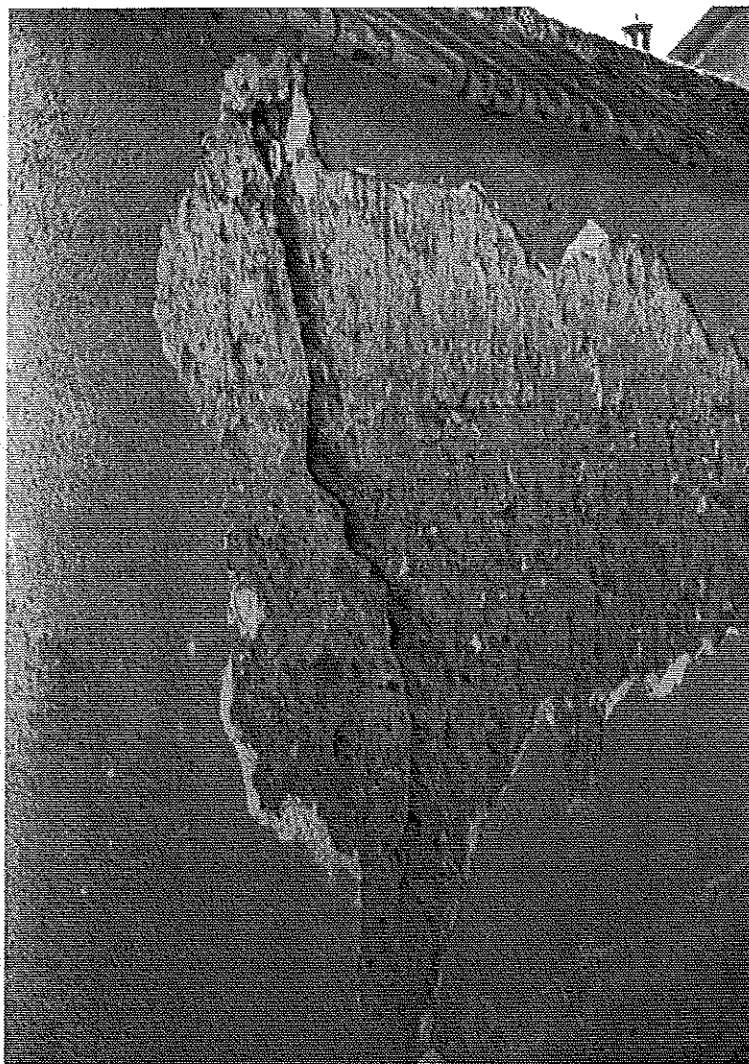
Fissuration dans une maçonnerie en pisé (tassement de sol) entraînant l'éclatement de l'enduit. © J. Putatti
